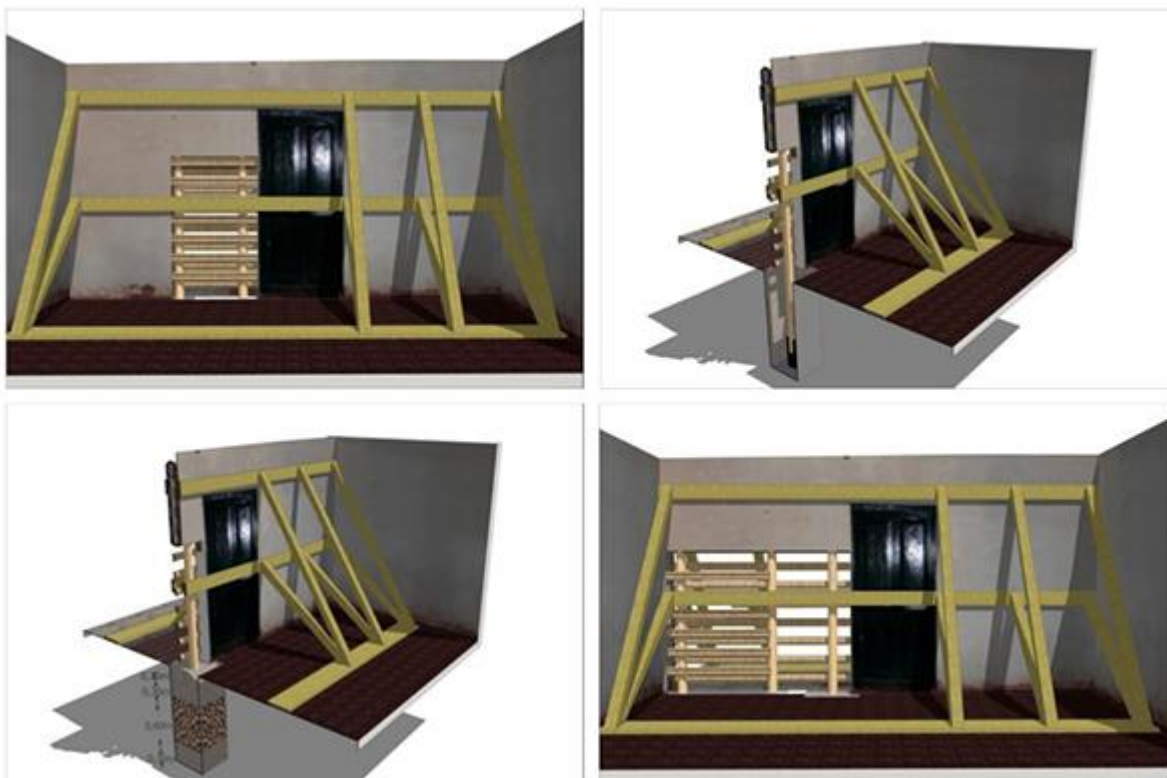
Simulación digital de la secuencia y fases del proceso constructivo. De izquierda a derechas las imágenes muestran: reemplazo pie derecho de la estructura del muro; vaciado de concreto pobre y viga de amarre; eliminación del embutido de barro localizado en medio del enlatado de guadua.
